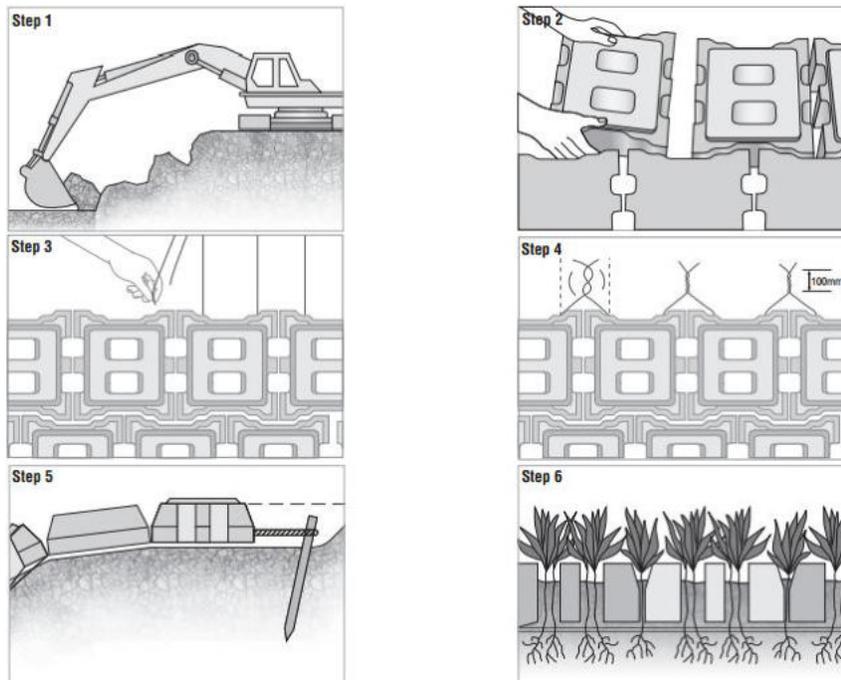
Método constructivo del recubrimiento con bloques de concreto articulados armados *in situ*.
